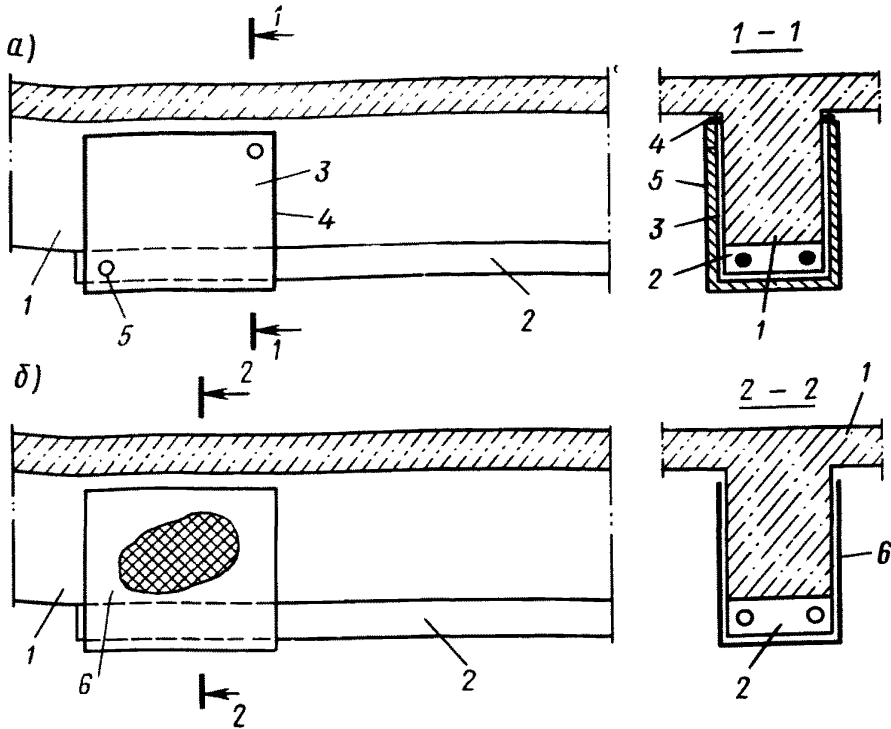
Обеспечение совместной работы элемента усиления с усиливаемой конструкцией поверхностным армированием
